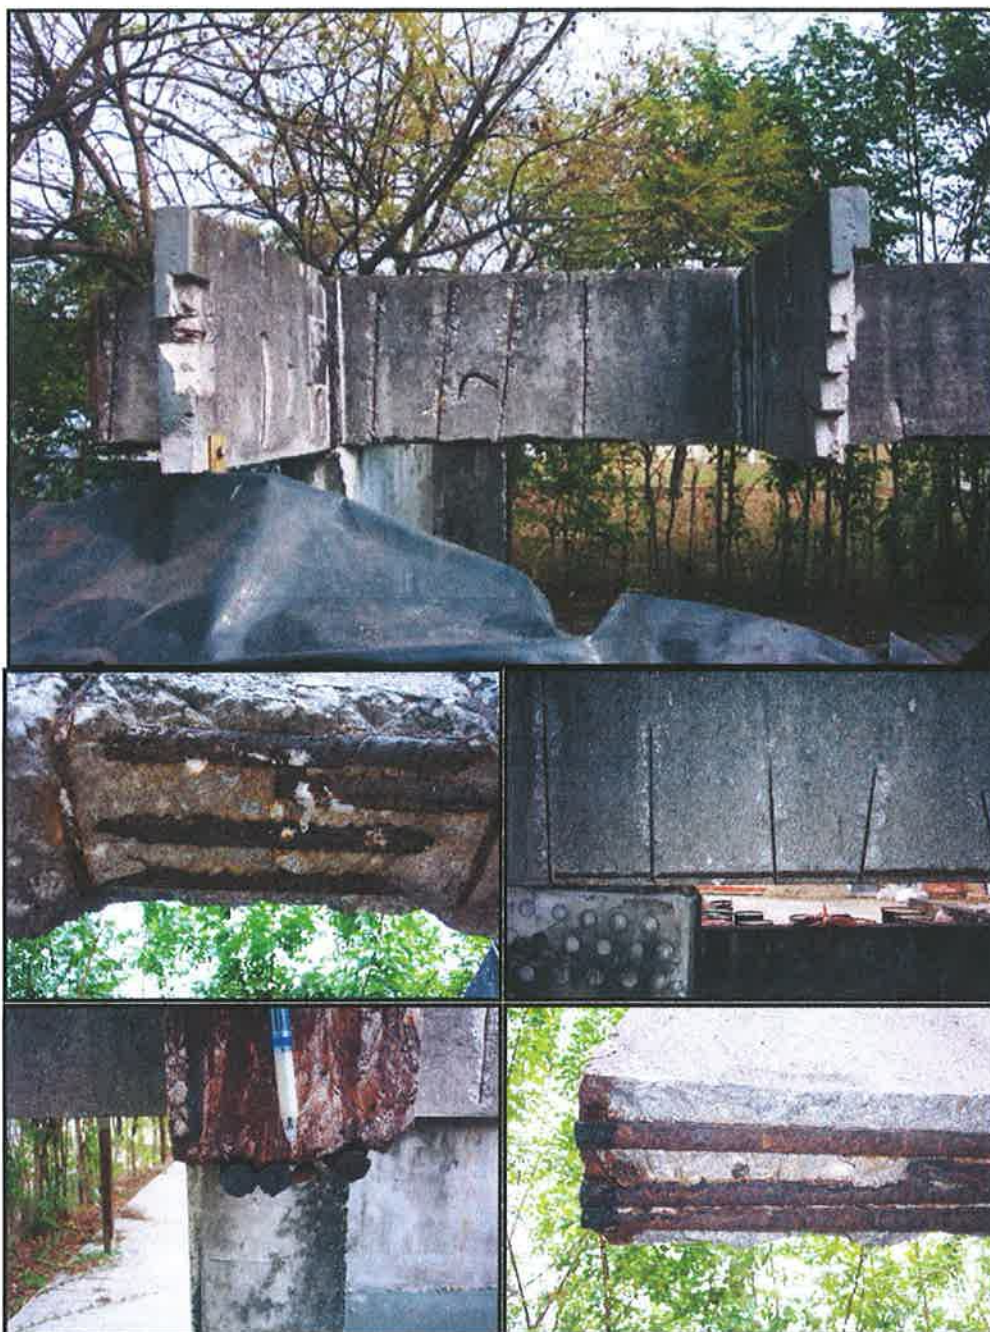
Exemplos do estado de deterioração do protótipo.
